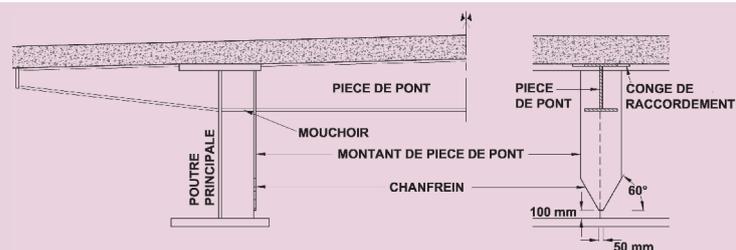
Liaison poutres principales/pièces de pont (cas courant)
